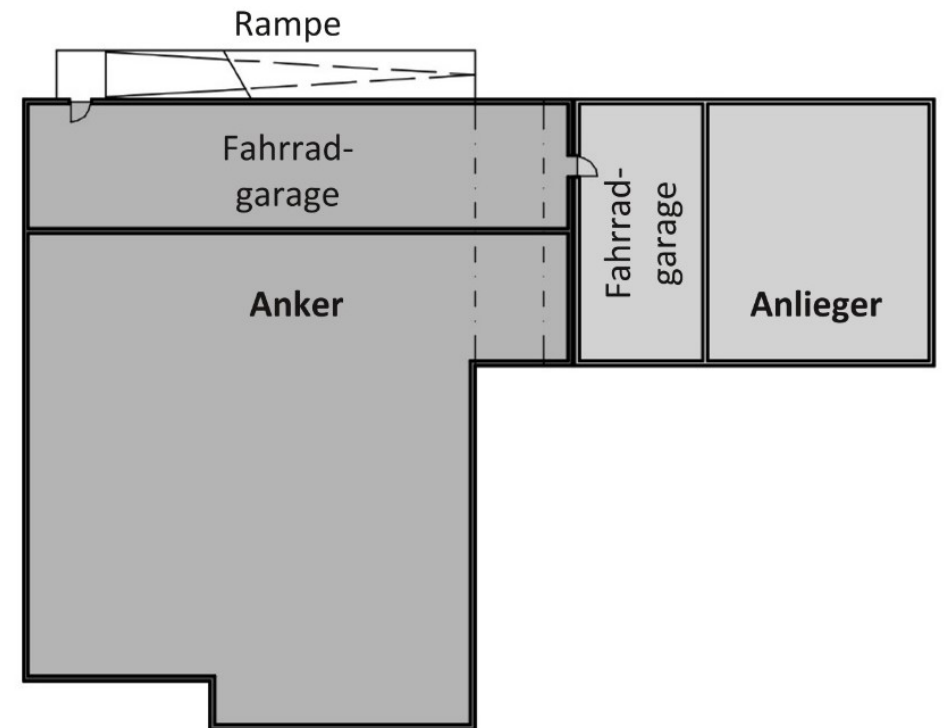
schematischer Grundriss des Untergeschosses vom MU 9 (ohne Maßstab)
